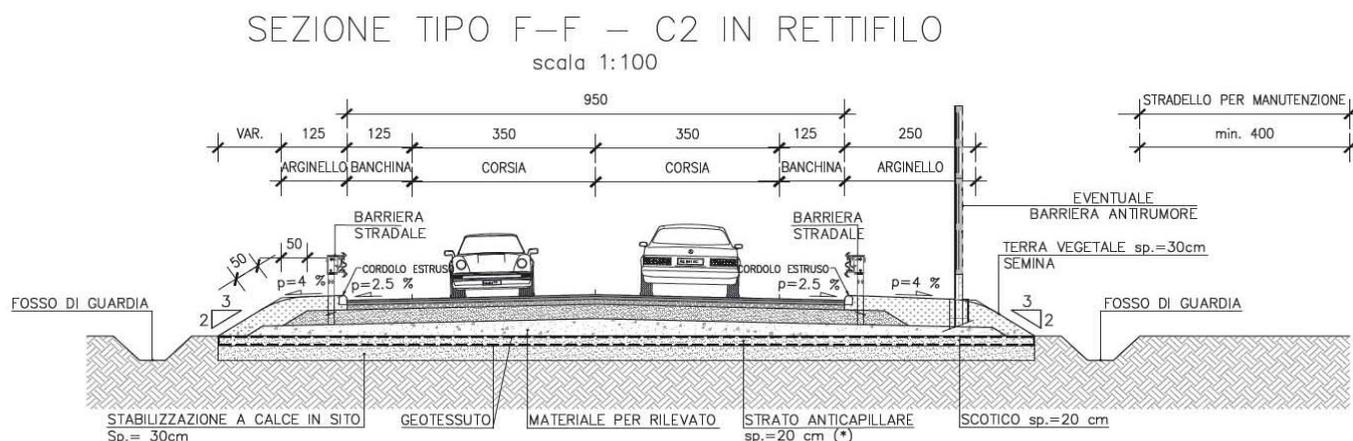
Sezione tipo piattaforma C2 in rettilifilo
